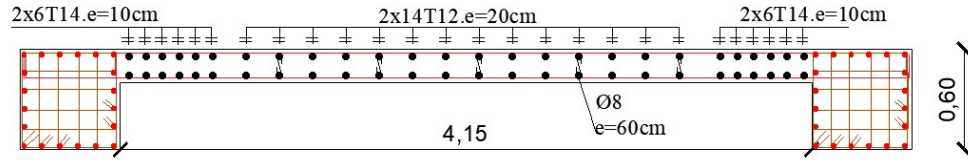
Exemple de ferrailage du voile RDC (L= 4.15 m)
